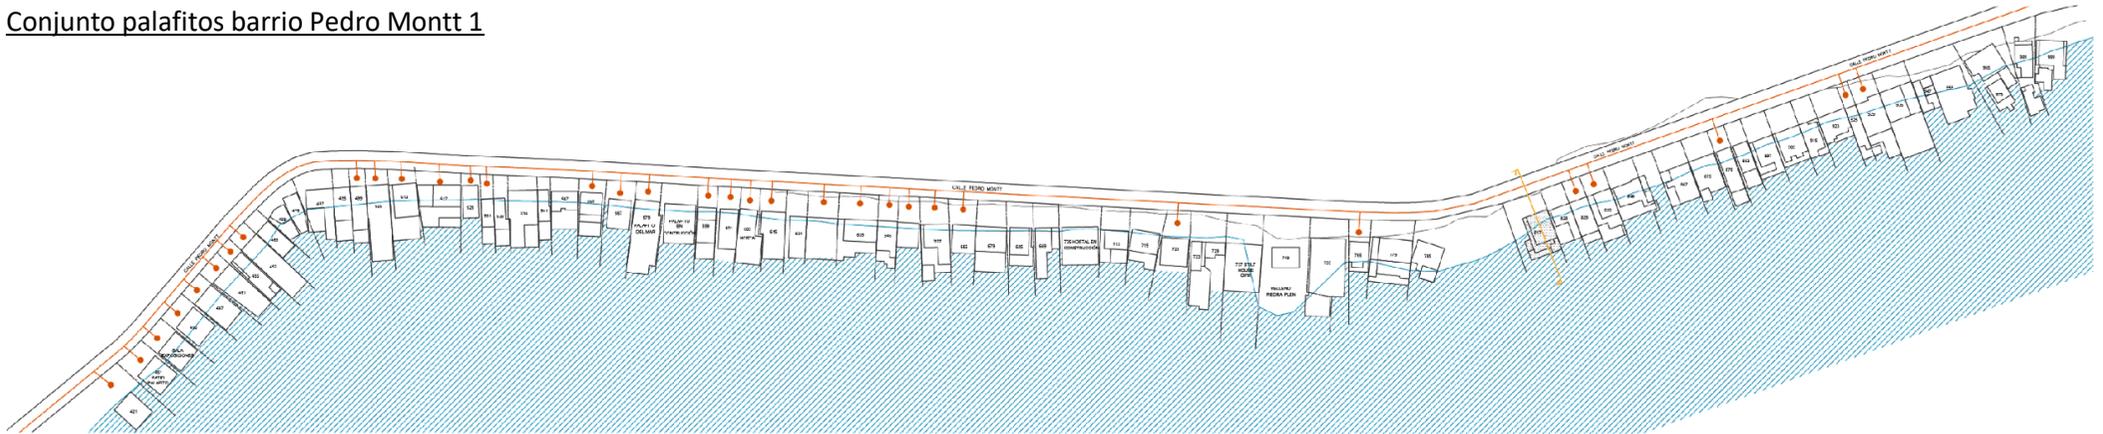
Planta conjunto Pedro Montt 1 de edificaciones palafito que están conectadas al sistema de alcantarillado según deducción a partir de análisis de construcciones bajo la cota de solera.
